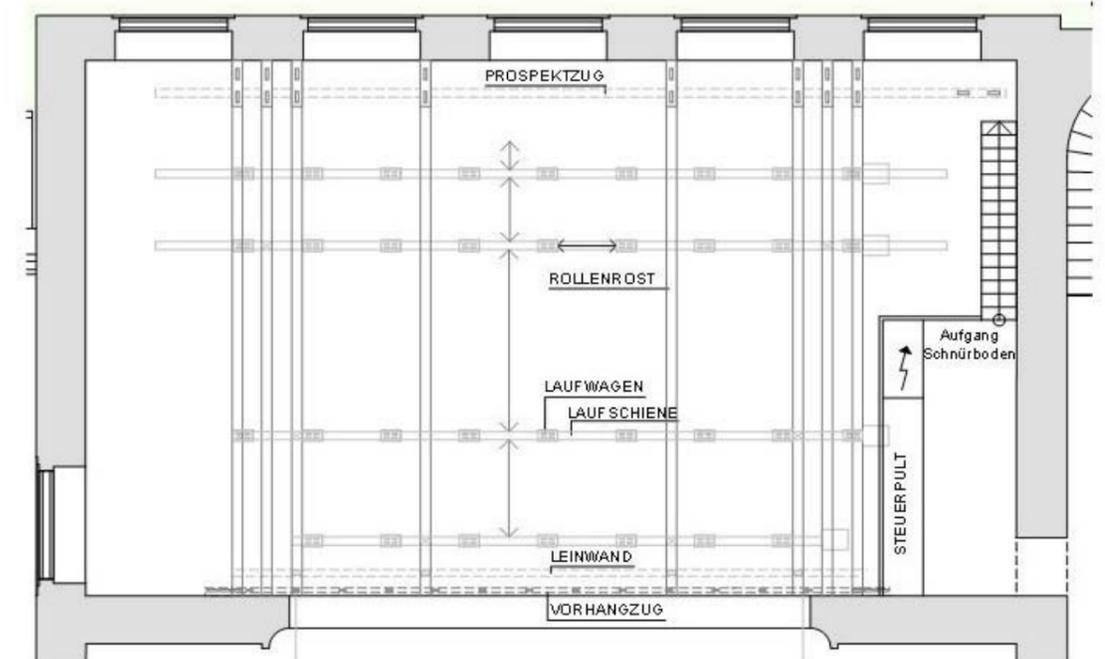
Grundriss Bühnenbereich
